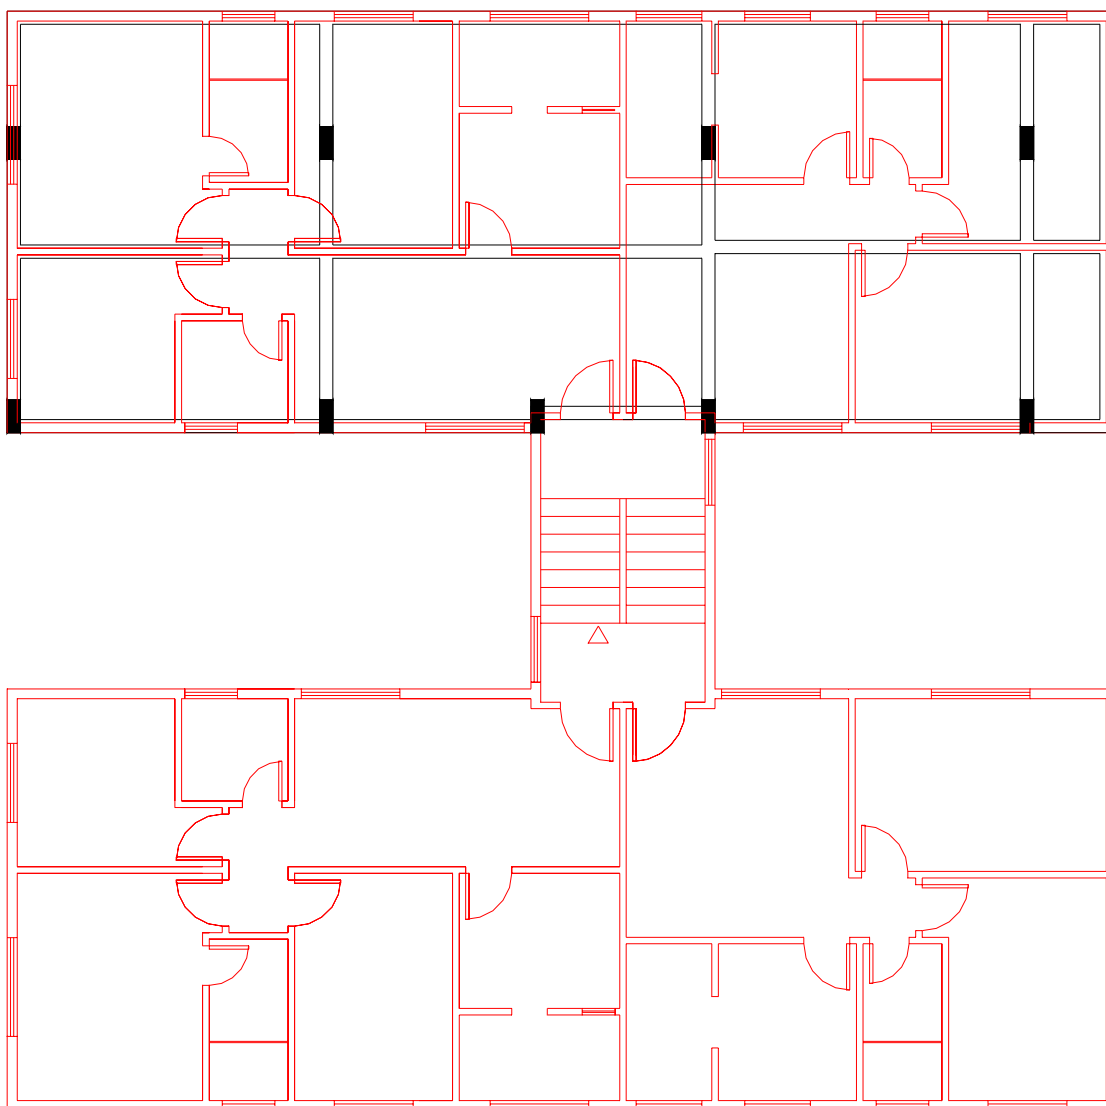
Residencial “S” – Superposição das alvenarias do pavimento tipo sobre a primeira solução de vigamento do pilotis
